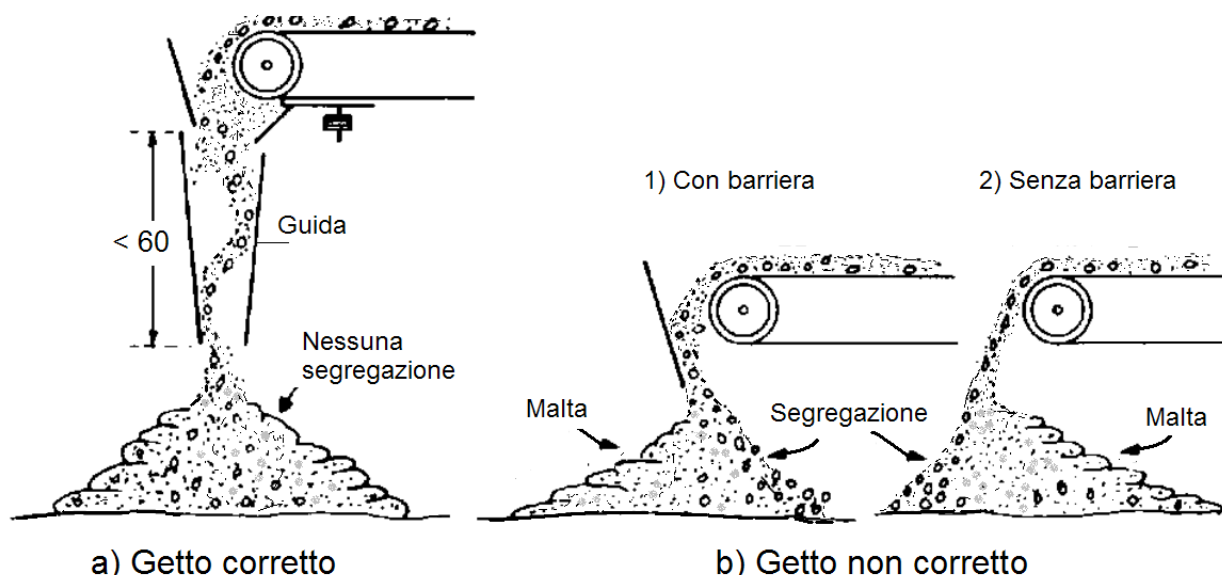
Esempi di getto di calcestruzzo con nastro trasportatore: a) getto corretto e b) getto non corretto. Nel caso b) si ha la separazione degli aggregati dalla malta cementizia. La barriera comporta soltanto il cambiamento di direzione della segregazione.
